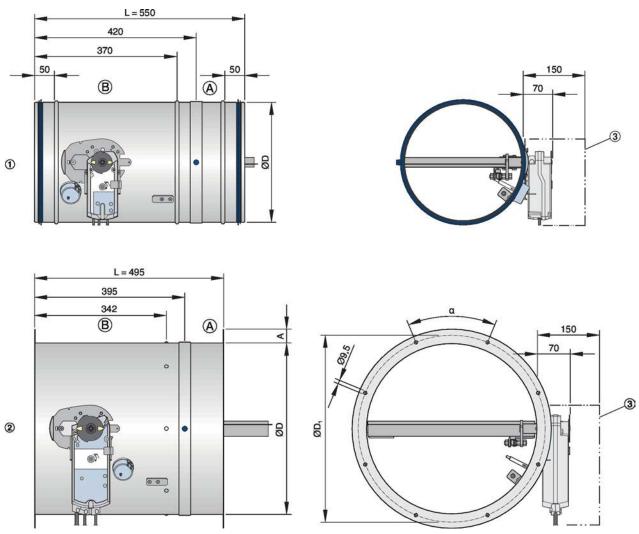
FKR-EU com atuador de retorno com mola Siemens
